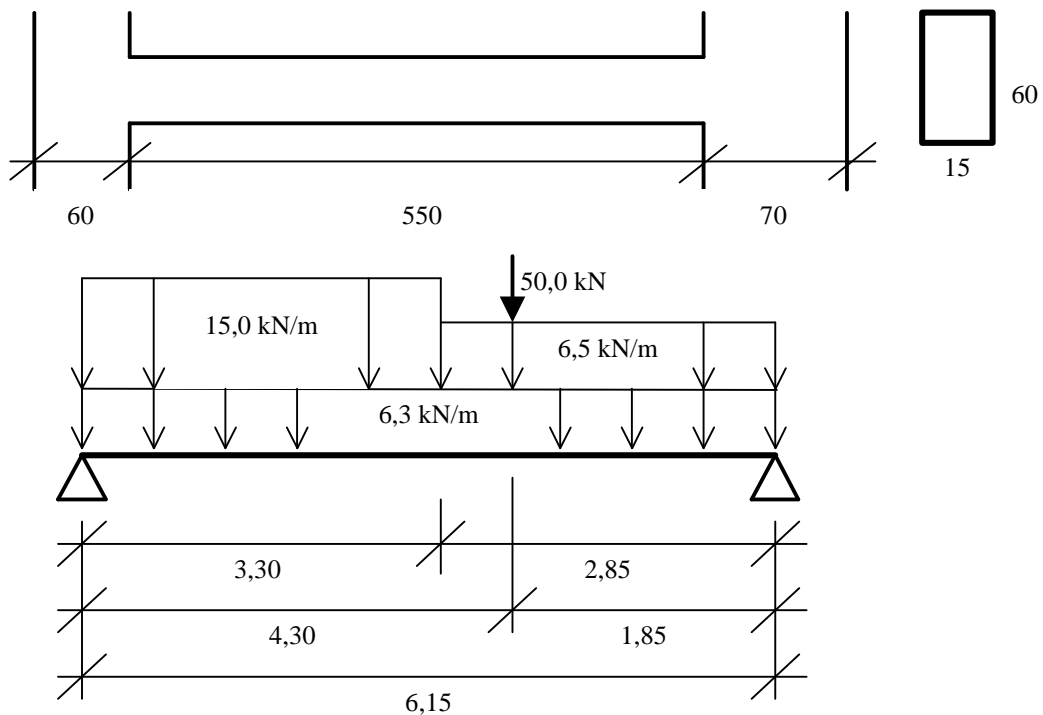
Dimensões e Carregamentos da Viga do Exemplo 2.
